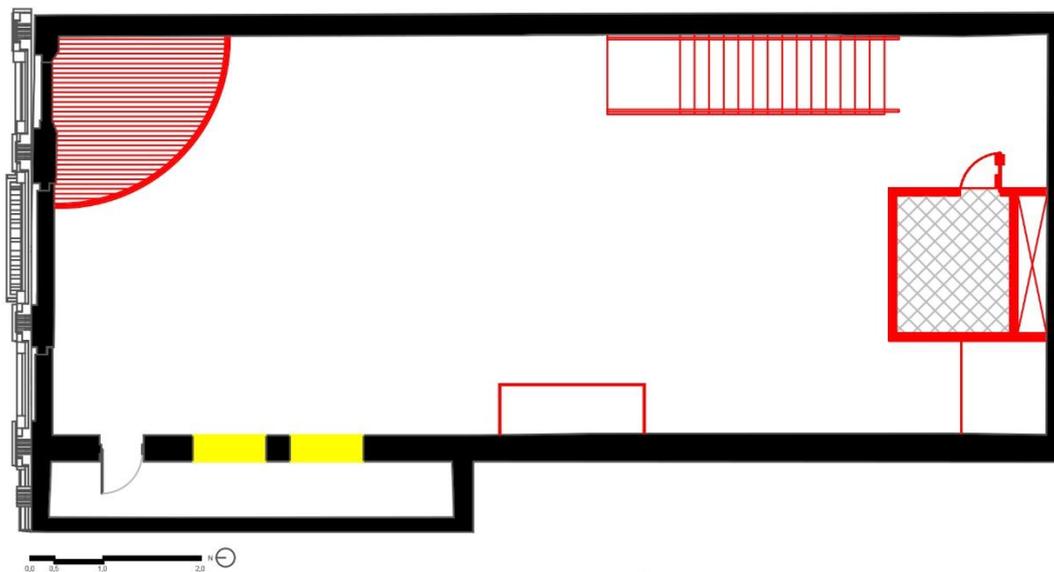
Planta baixa Remover/Construir do pavimento térreo.
